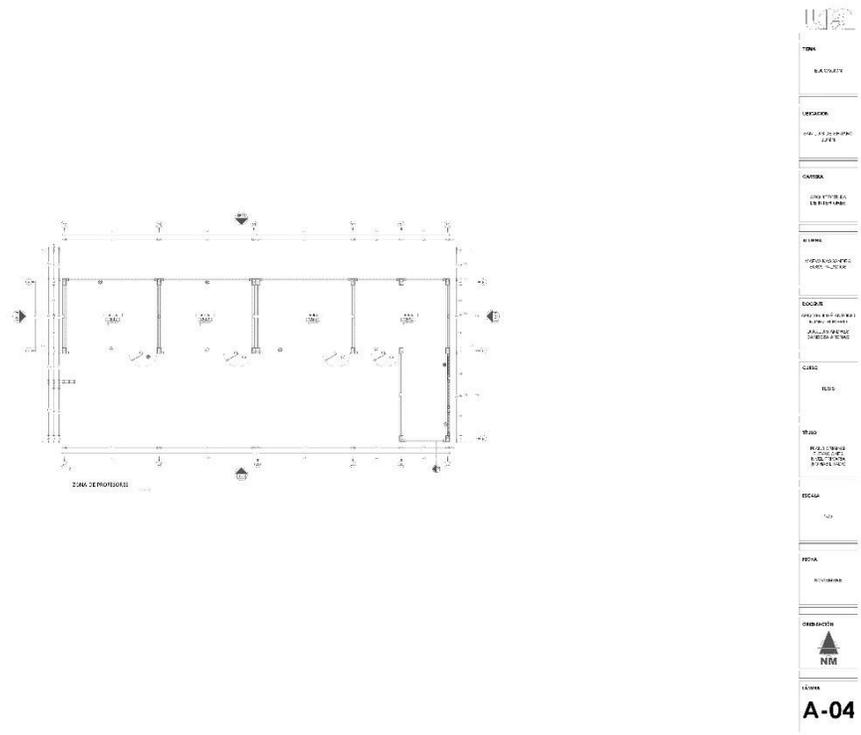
Planimetría Existente de la Municipalidad de San Luis de Shuaro. Fuente: Maeva Sosa
